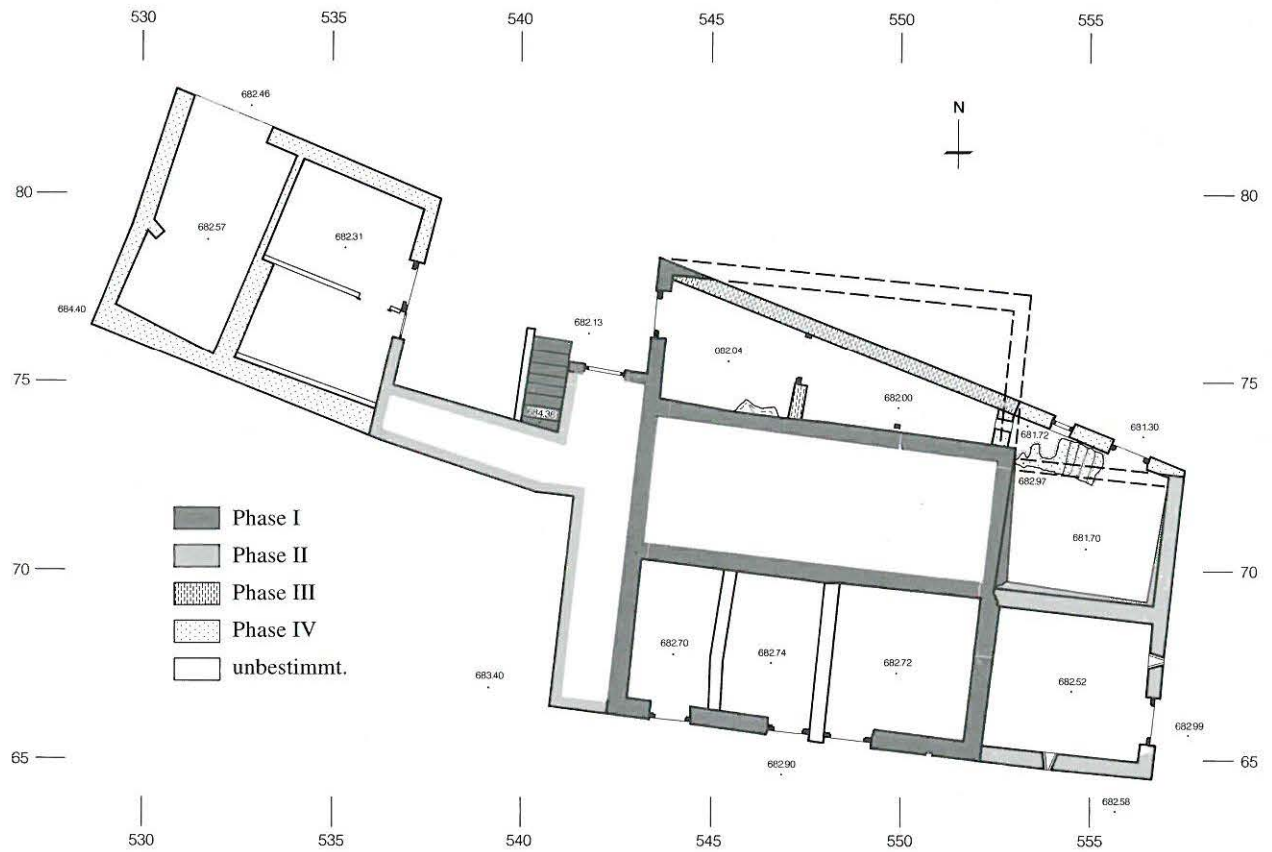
Brienzwiler, Staatsstrasse 4. Grundriss mit Bauphasen. M. 1:200.
